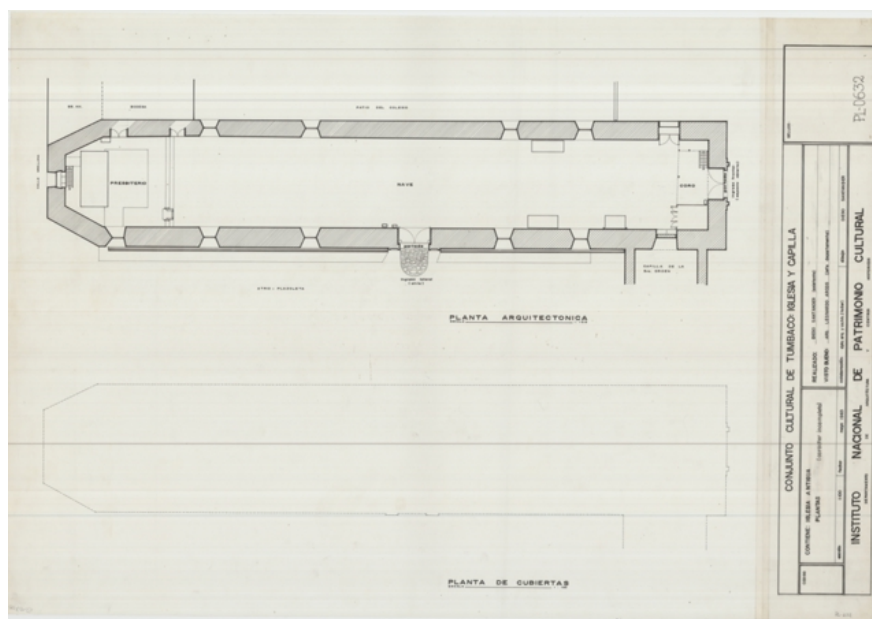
Planta arquitectónica y de cubiertas estado original.
